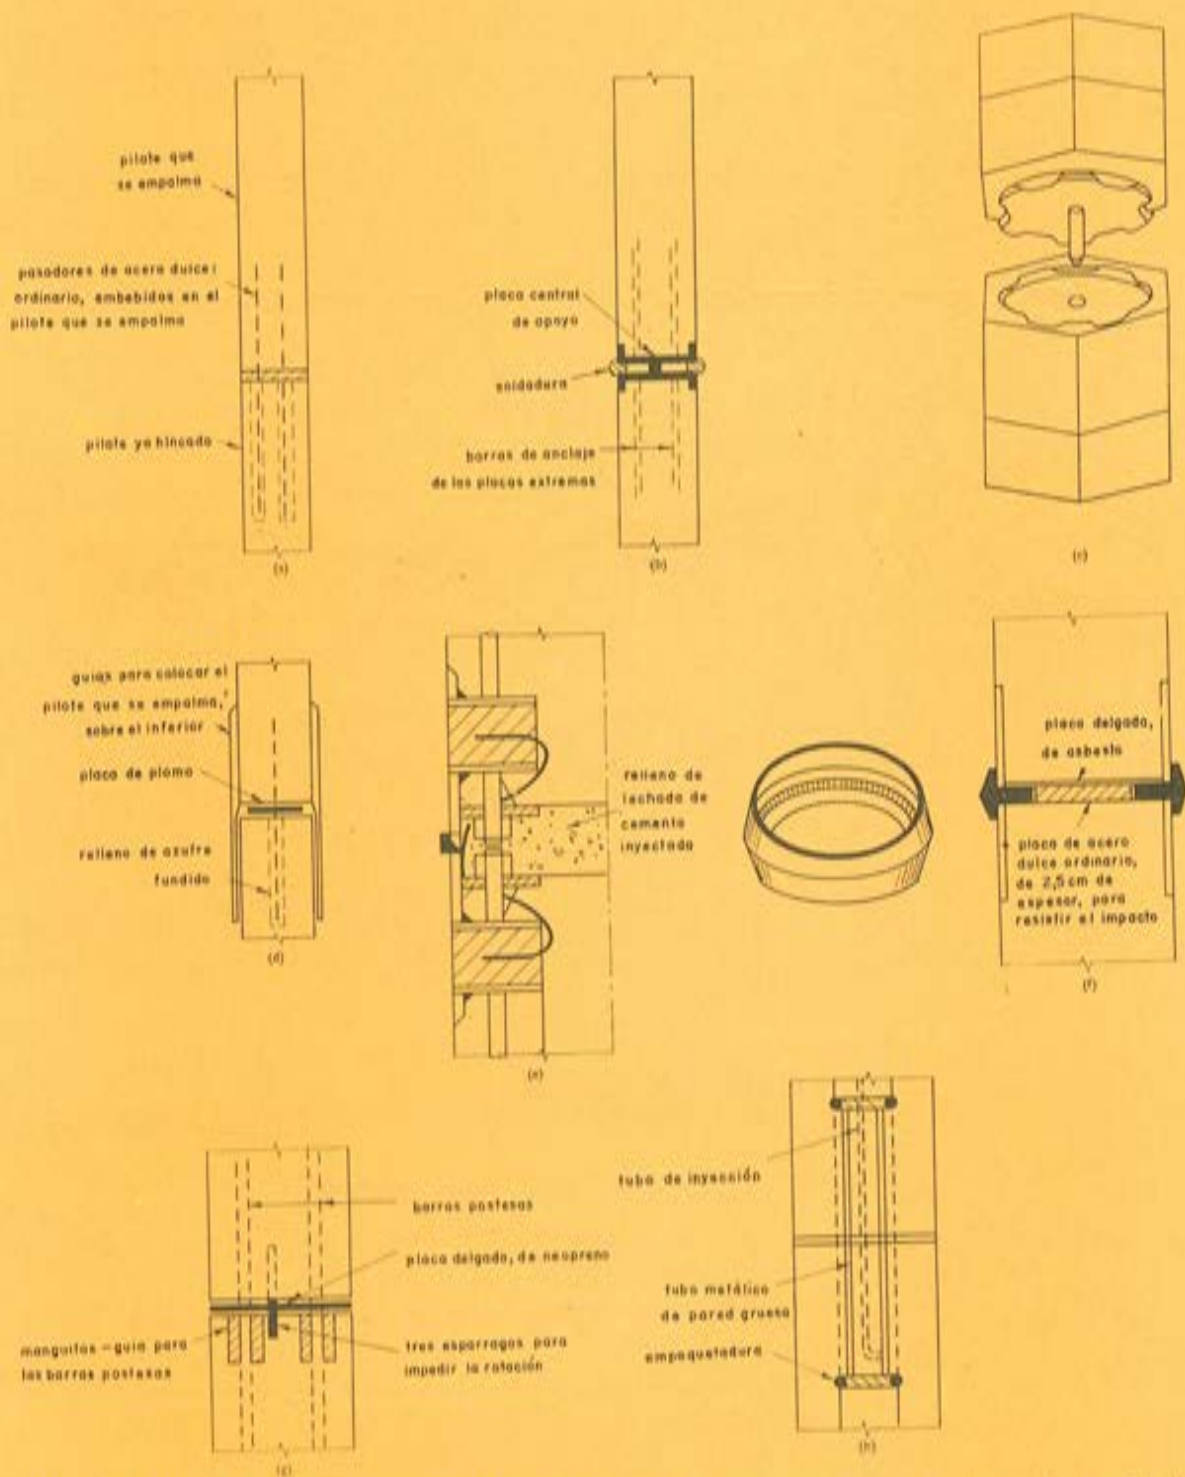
Detalles de diversos tipos de empalmes de pilotes de hormigón pretensado. a) empalme mediante pasador y junta epoxi (Estados Unidos, Noruega); b) empalme por soldadura; c) empalme por soldadura (patente japonesa); f) empalme tipo "Brunsplice" (patente norteamericana); g) empalme mediante postensado (Gran Bretaña); h) empalme mediante tubo de acero en pilotes huecos (Noruega).
